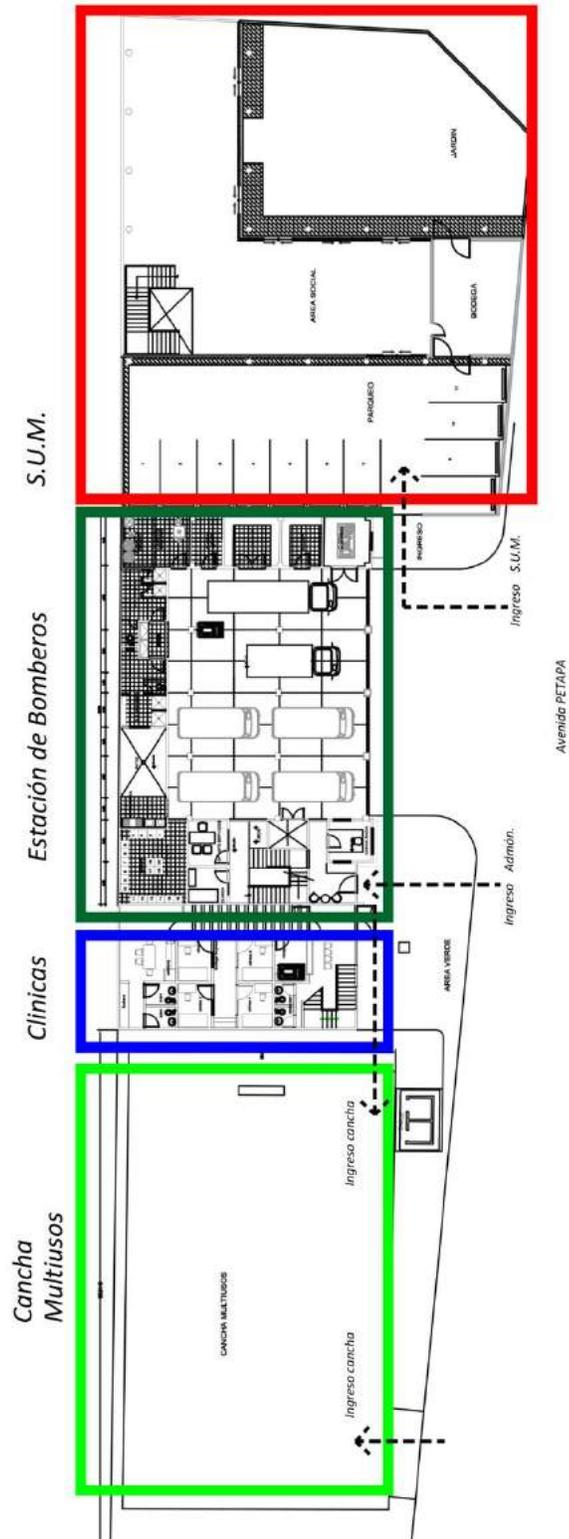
Planta primer nivel CBM 7. Fuente: CBM. Edición: Zonificación elaboración propia
